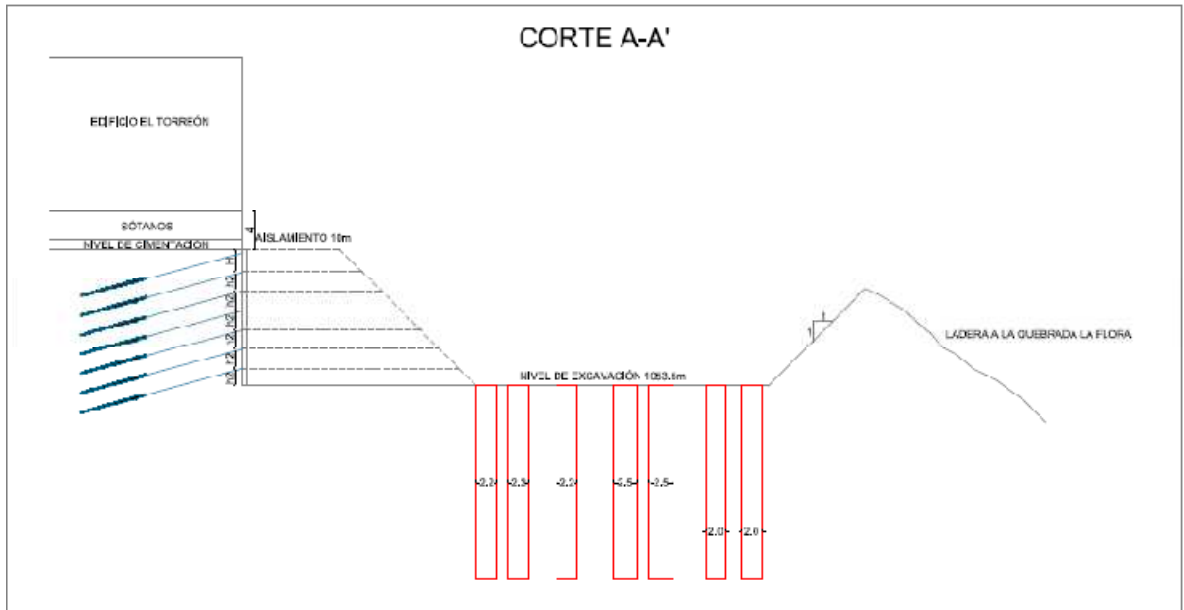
Paso 2.9: Se repiten los pasos 2.2 y 2.6 para la instalación de cada una de las filas de anclajes, se llega hasta el nivel de excavación, terminando así la construcción de la pantalla.
